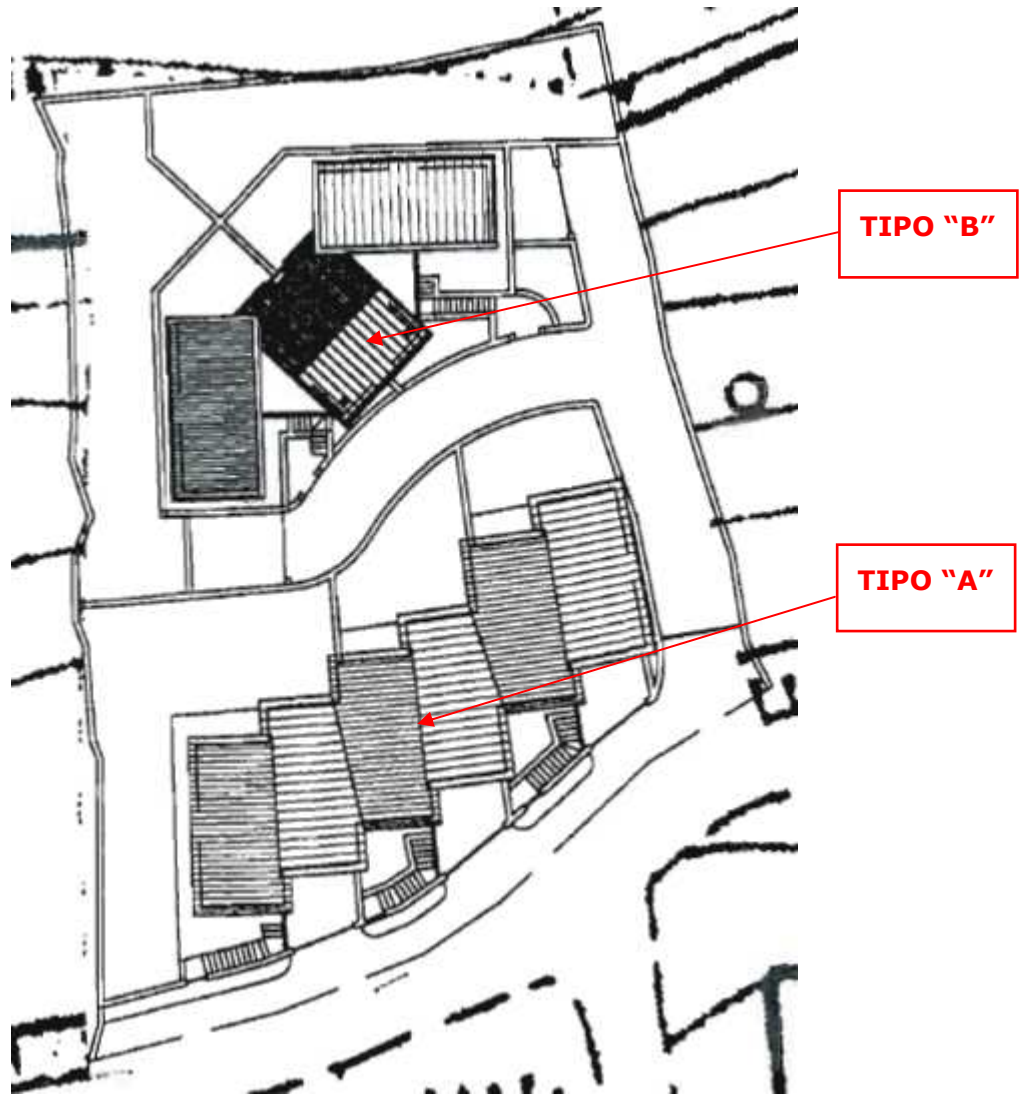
Stralcio planimetrico di inquadramento estratto dal progetto autorizzato con indicazione del fabbricato di valle (Tipo "A") e di quello di monte, attualmente non realizzato (Tipo "B")
